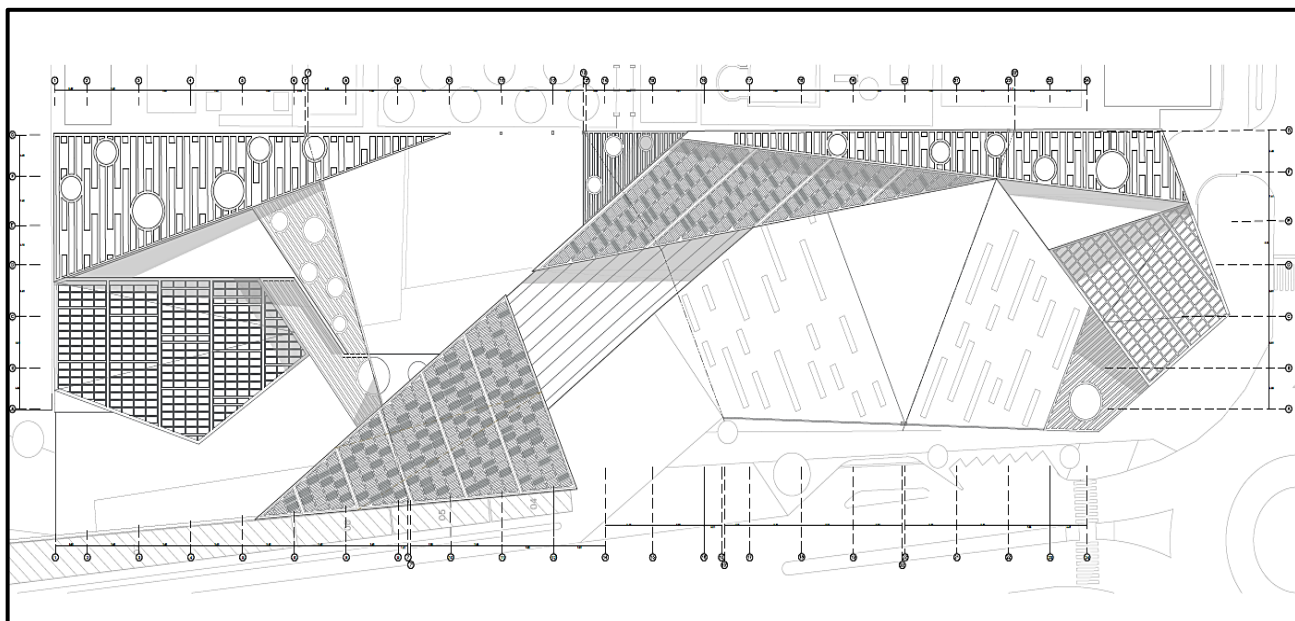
Planta de 4to Nivel Proyecto Parque Cultural
